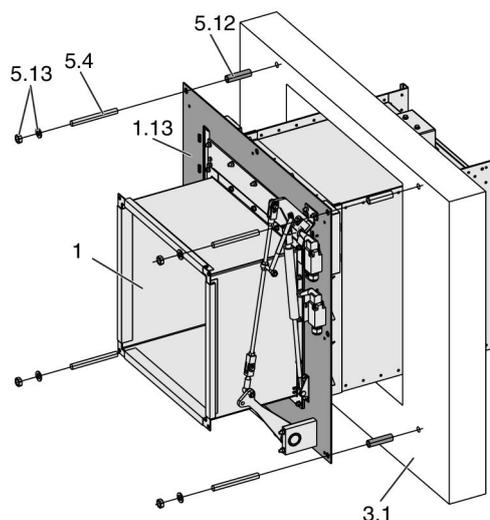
Einbau in Massivwand (mit Metallspreizdübel – Betonwand)
